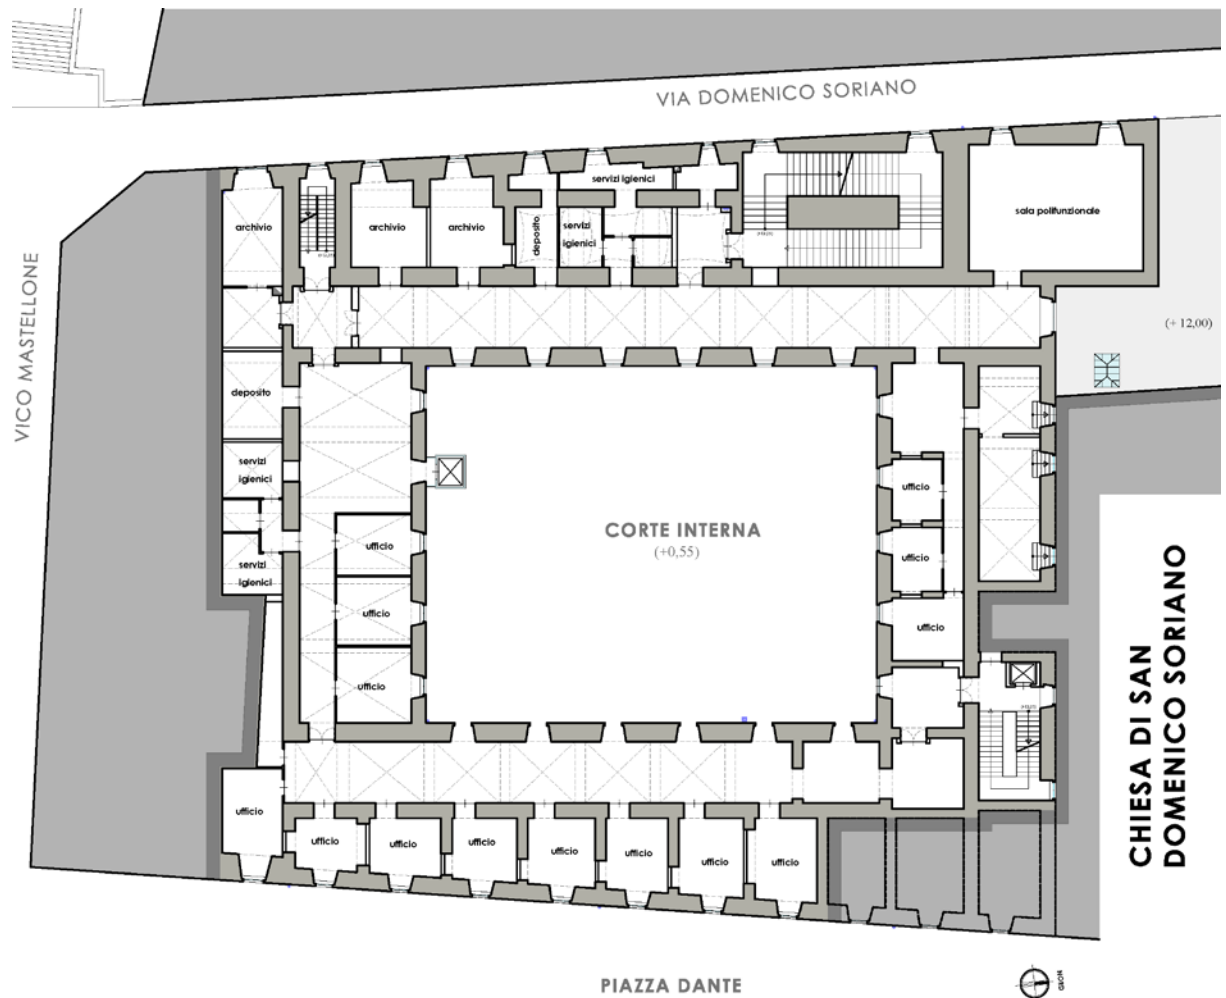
Indicazioni progettuali: Pianta Piano Secondo
